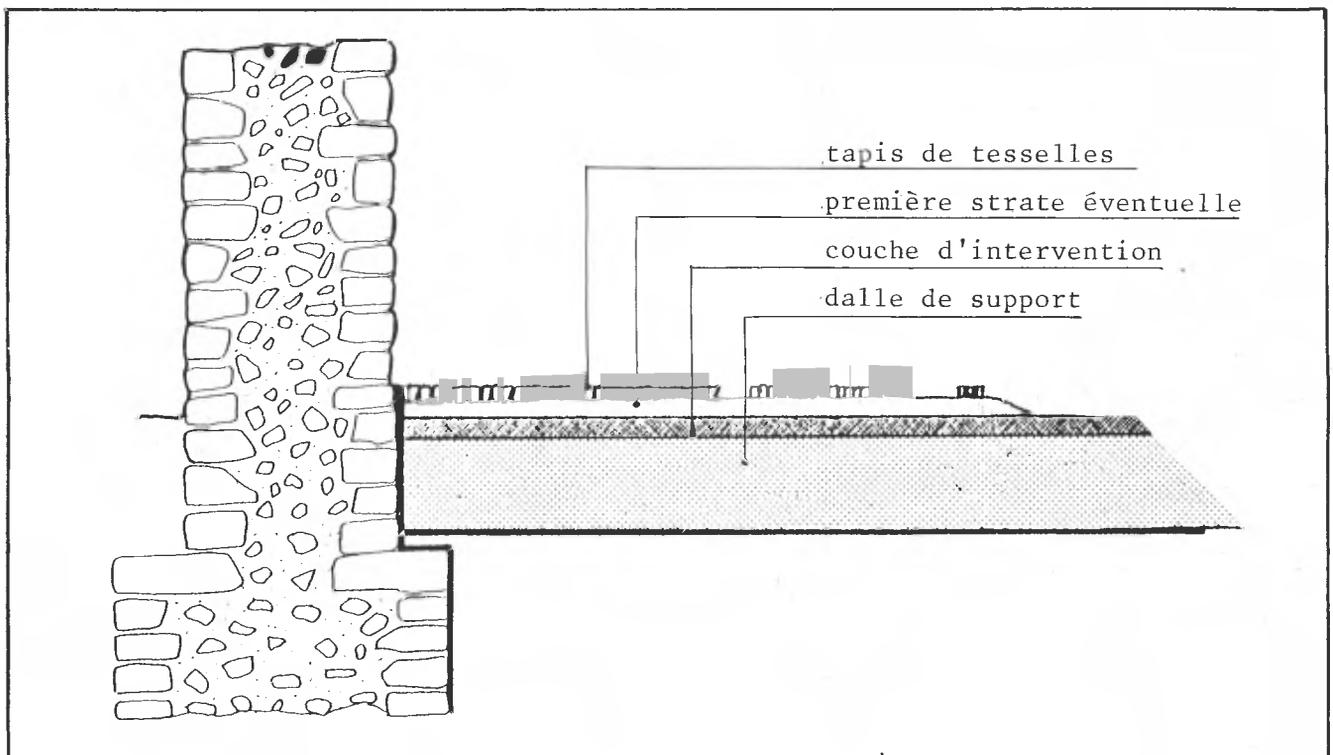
a) Mosaïque transférée sur un plancher fixe de béton de ciment armé avec couche d'intervention.
